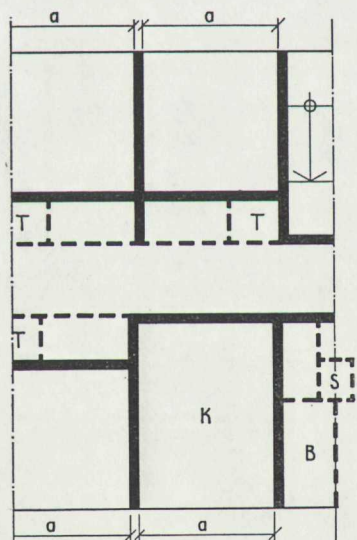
Serie 15: B.3.2. Samma mått och samma standard som 15: B.3.1. Gemensamhetsutrymmenas storlek bestäms av rummens bredd och yta samt av minimibredden på badrummet
